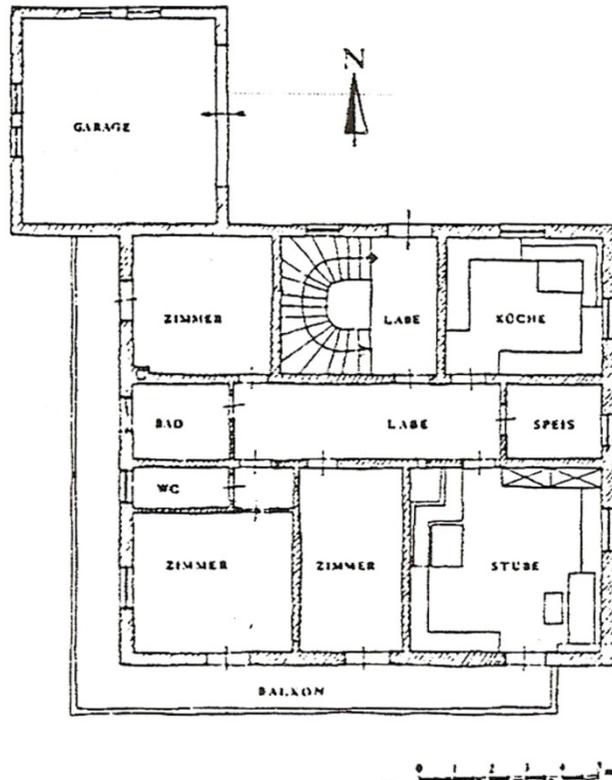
T-Flurgrundriss, 20. Jahrhundert
